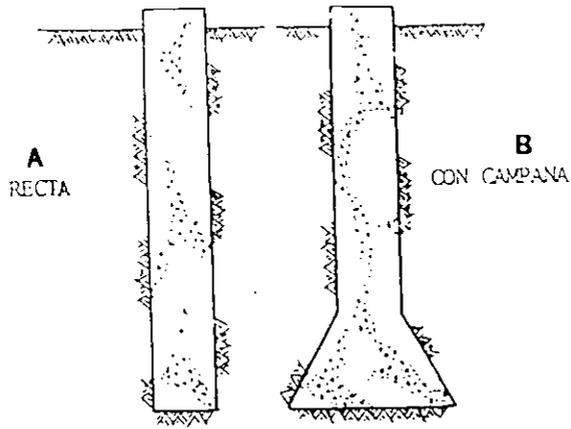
CLASIFICACIÓN DE LAS PILAS SEGÚN SU GEOMETRÍA.
